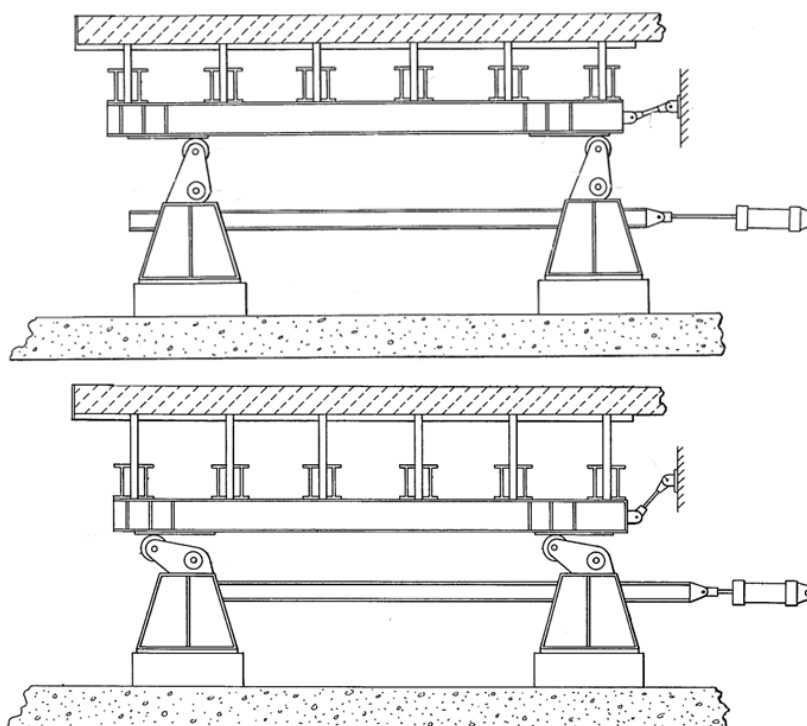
Netradičně řešený krokovací mechanismus. [3]
